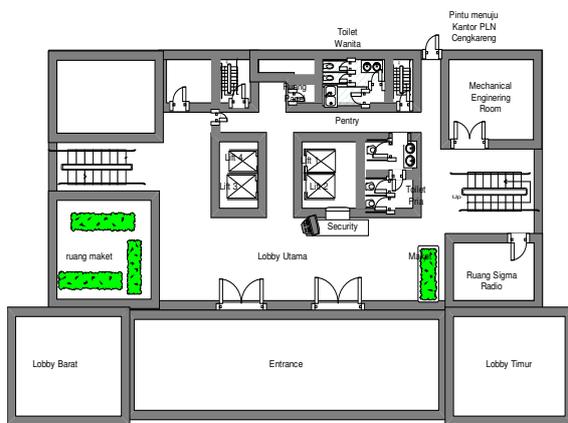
(b) Denah asli gedung tampak barat dan bentuk nyata saat ini (Sumber : Denah dari KBSRT STT-PLN)
